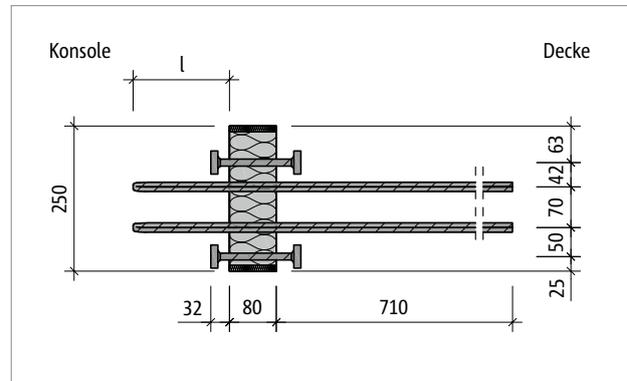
Schöck Isokorb® T Typ O-X80: Produktgrundriss
